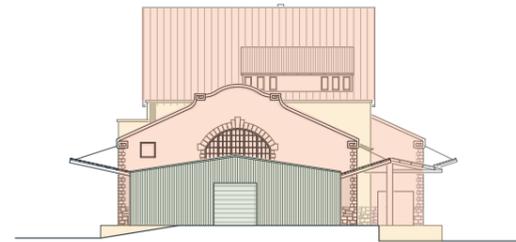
Planansicht der Südfassade, 2022 M 1:500
